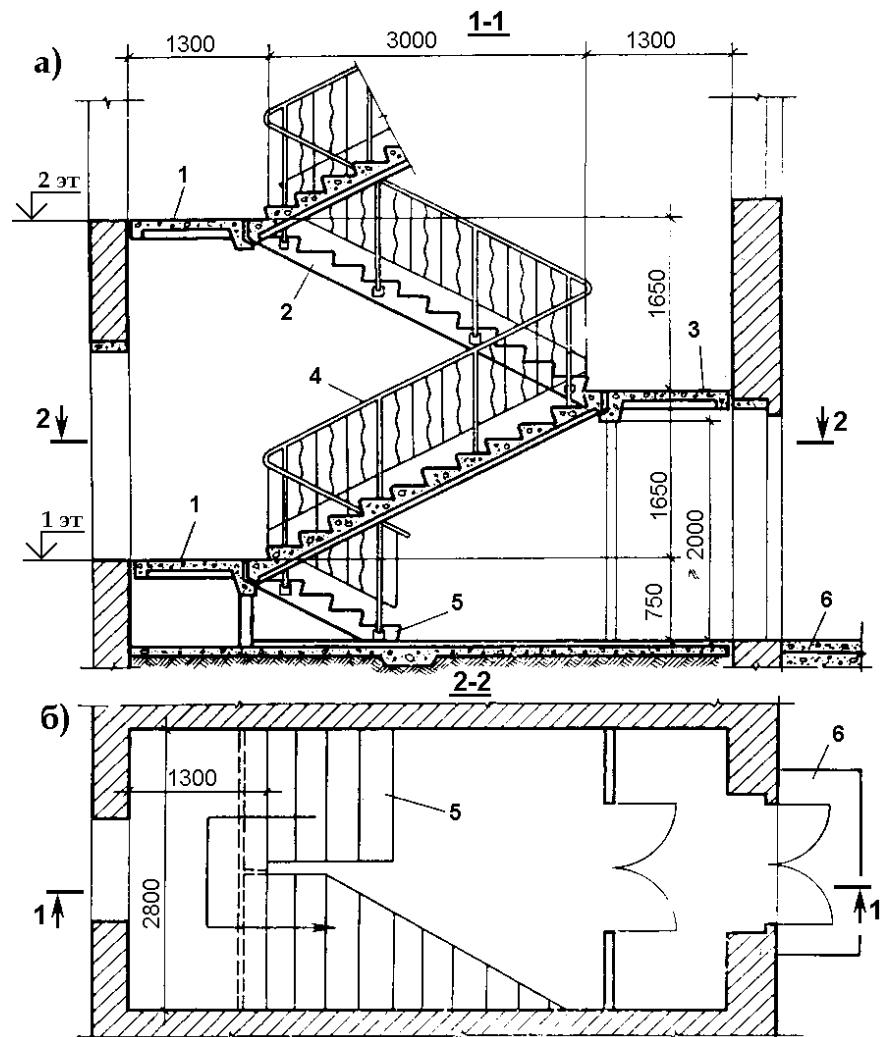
Двухмаршевая лестница из сборных железобетонных маршей и площадок.
